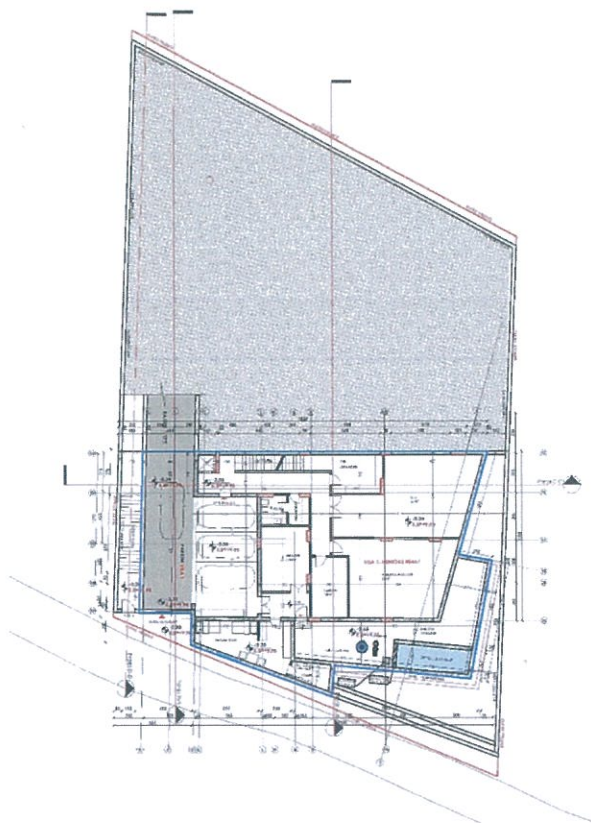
Planimetria e nëntokës Vila 1/Parkimet
